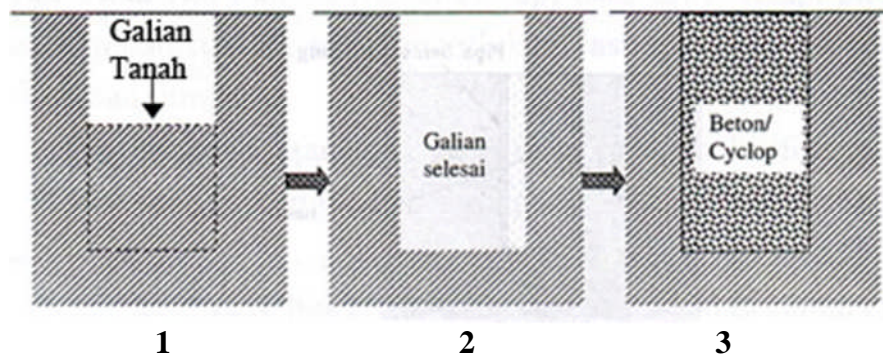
Bentuk – bentuk Tampak Sumuran
